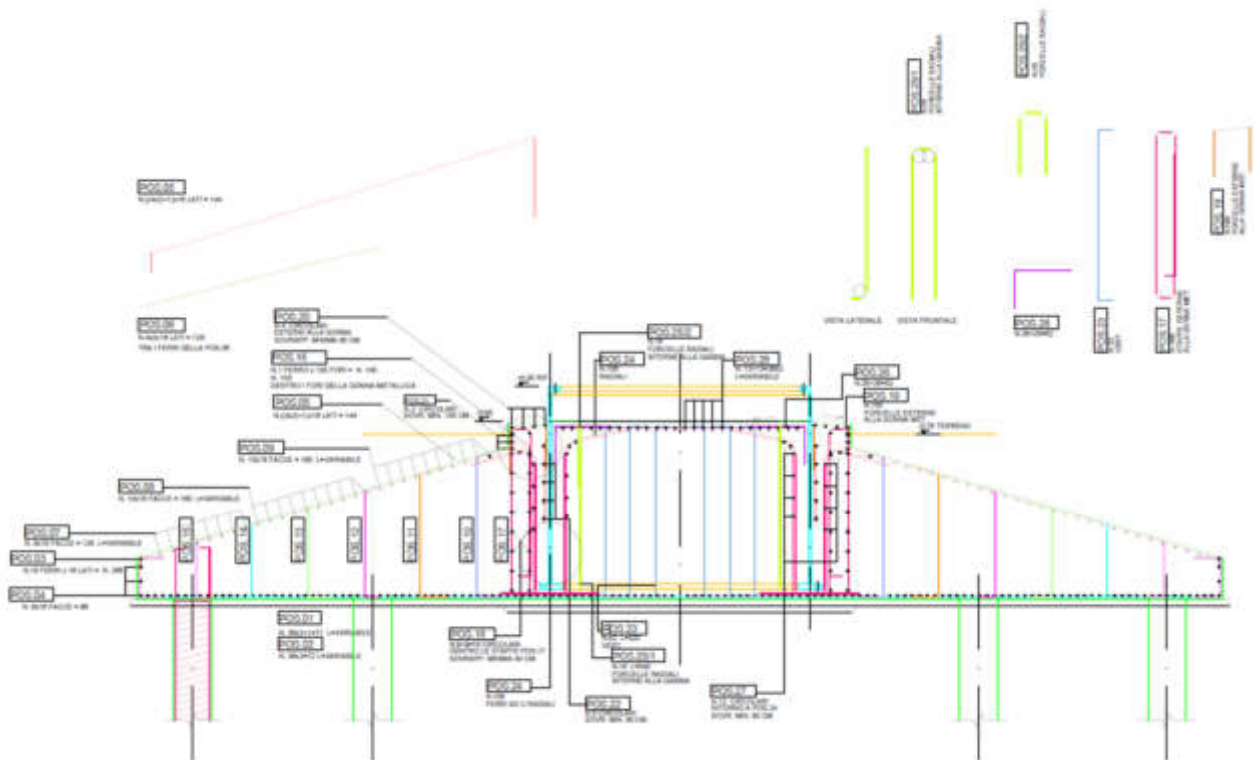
Pianta-sezioni e armature del plinto di fondazione
